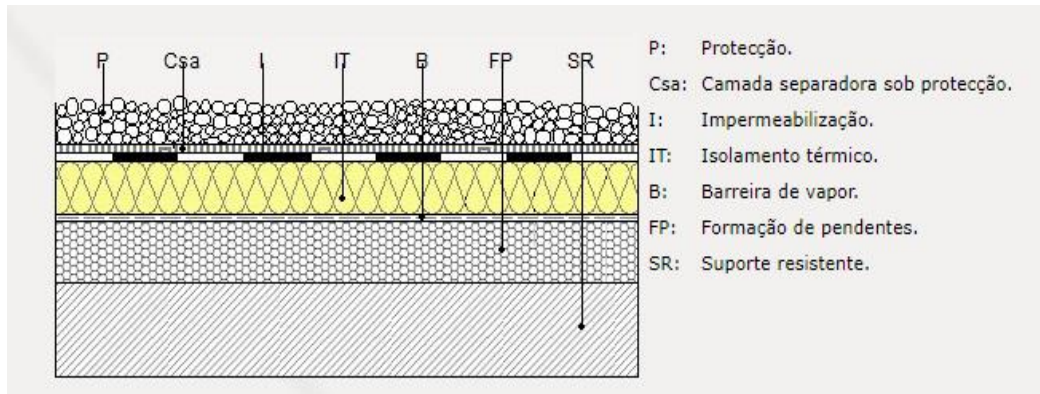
Pormenor construtivo tipo de uma cobertura plana tradicional [36]
